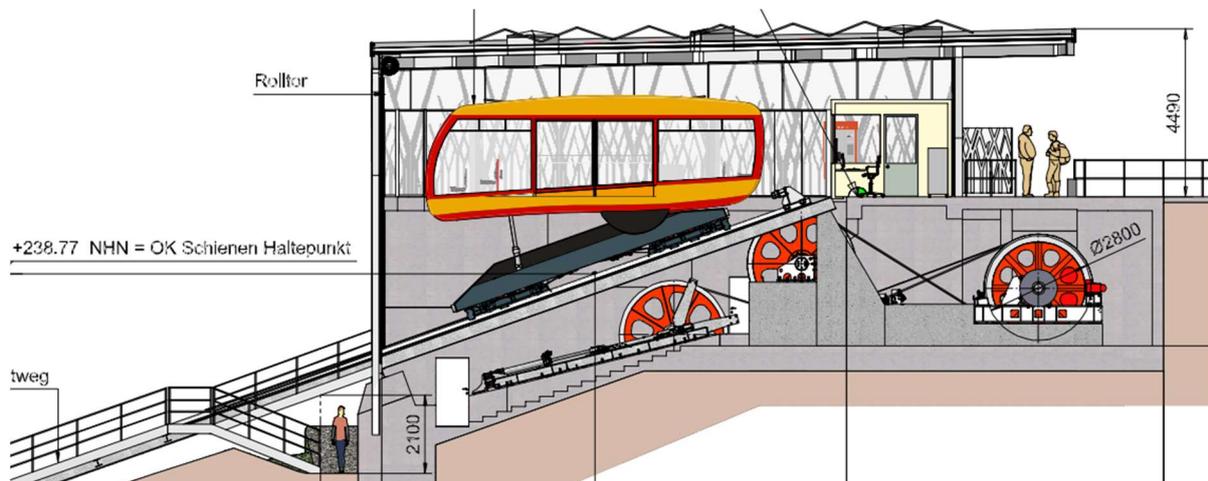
Schnitt geplante Bergstation mit ebenerdigem Ein-/Ausstieg (Quelle: Garaventa), siehe Plan-Nr. 4304
